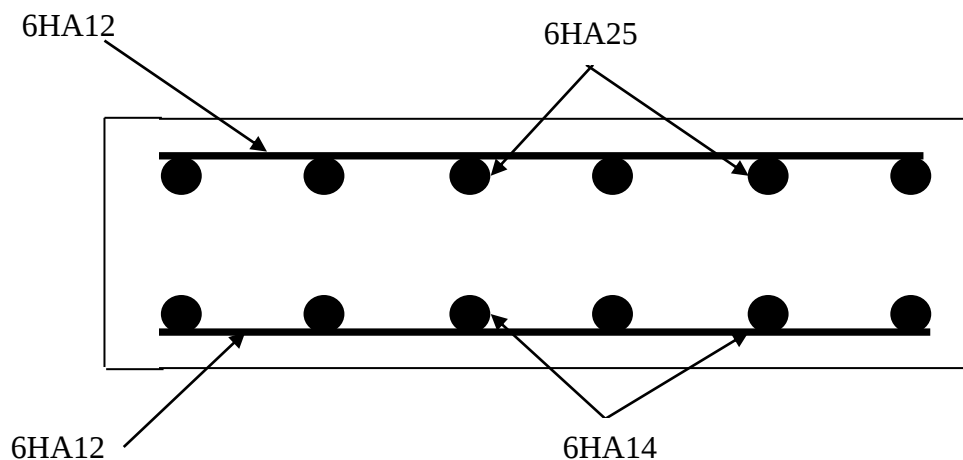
Ferrailage du en retour (Vue en plan)
